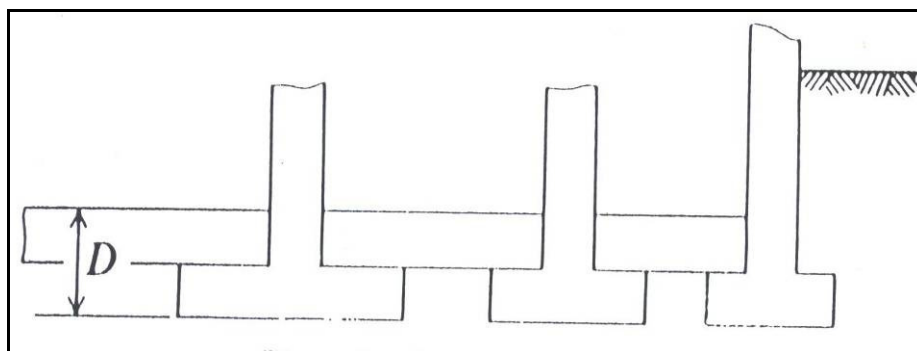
definizione di ricoprimento minimo delle fondazioni D.
